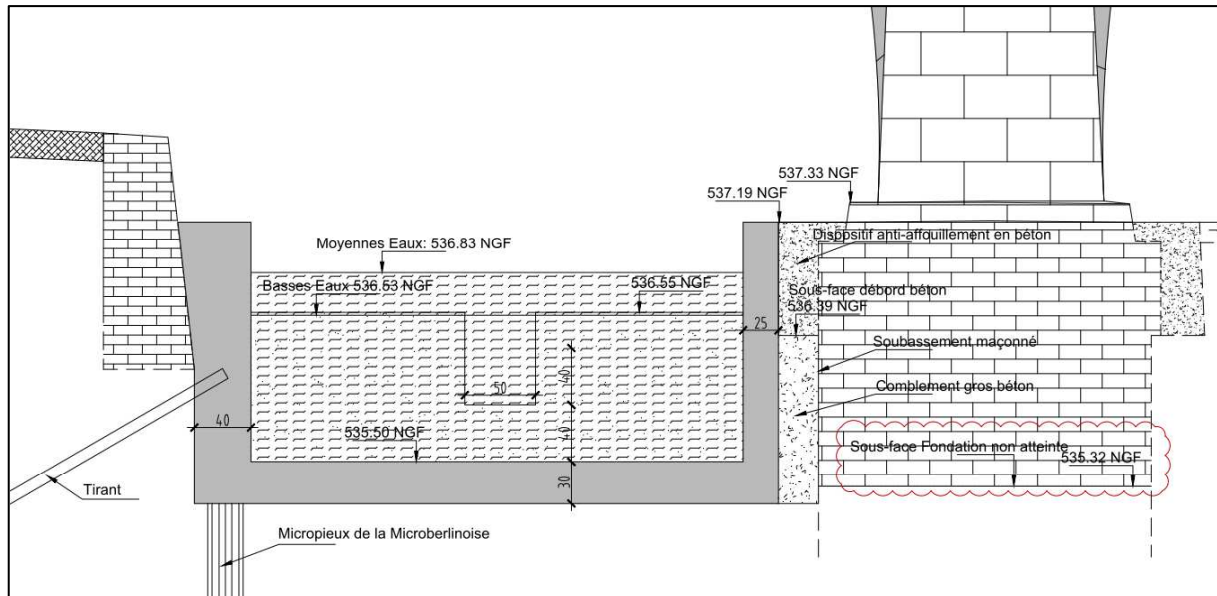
Coupe de principe gros œuvre sur la passe à poissons
